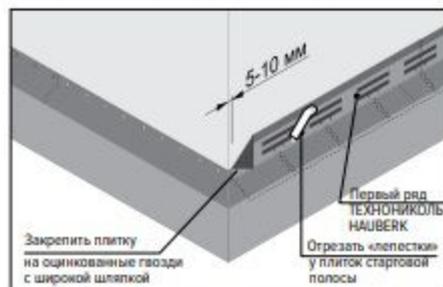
Монтаж стартовой полосы фасадной плитки
